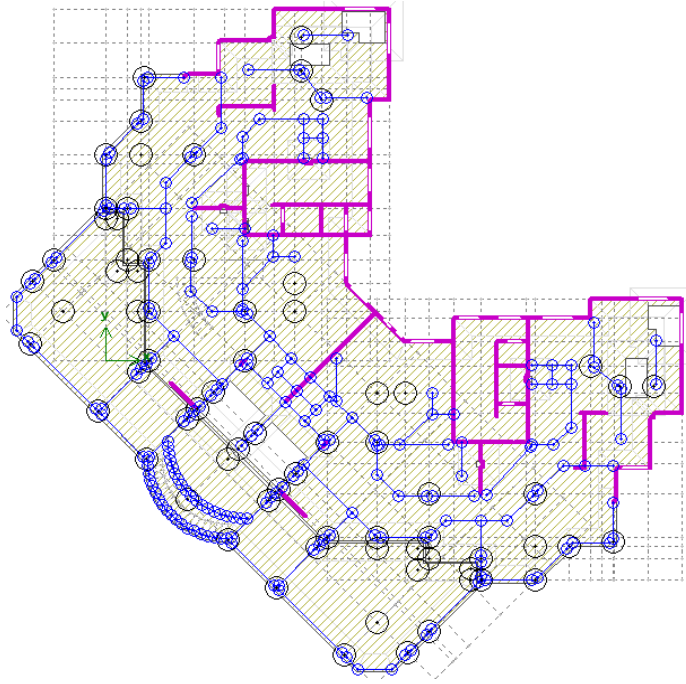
Розрахункова схема будівлі на відм 0,000
